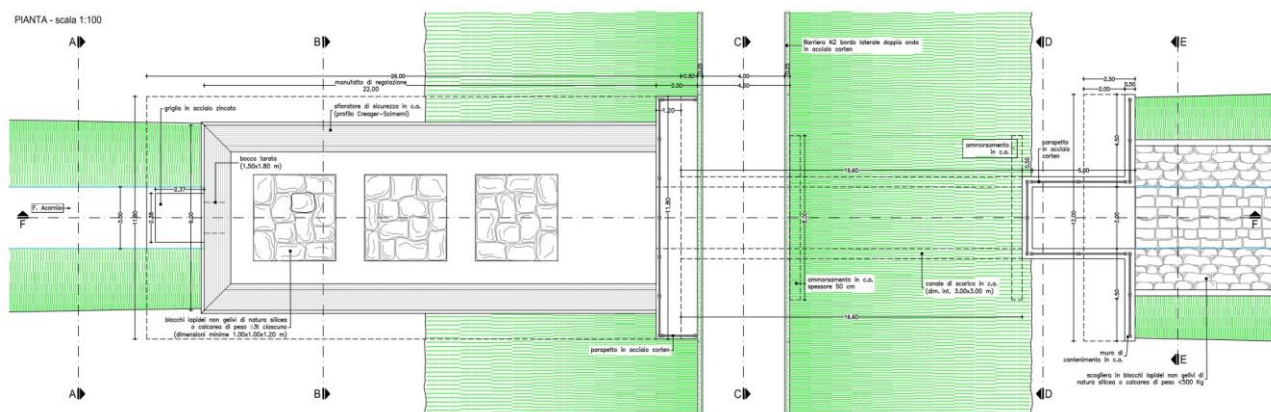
Planimetria di dettaglio manufatto di regolazione e scarico in c.a.
